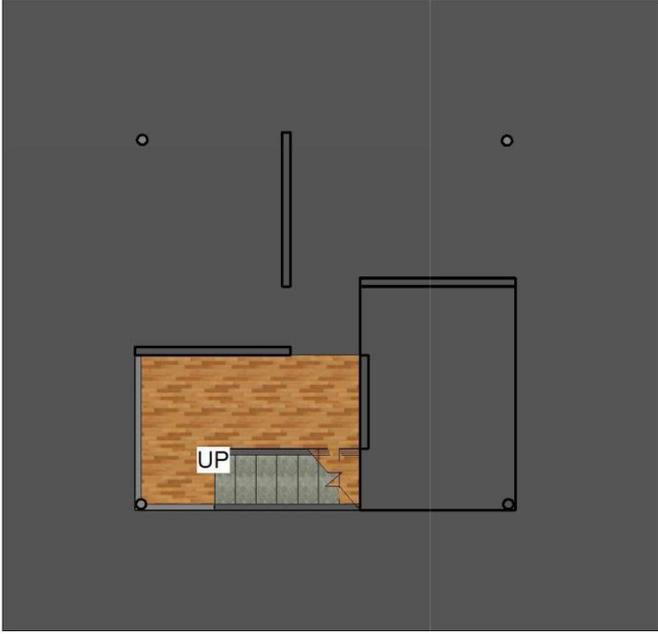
Estructura Museo Ahmedabad. Elaboración Propia.
